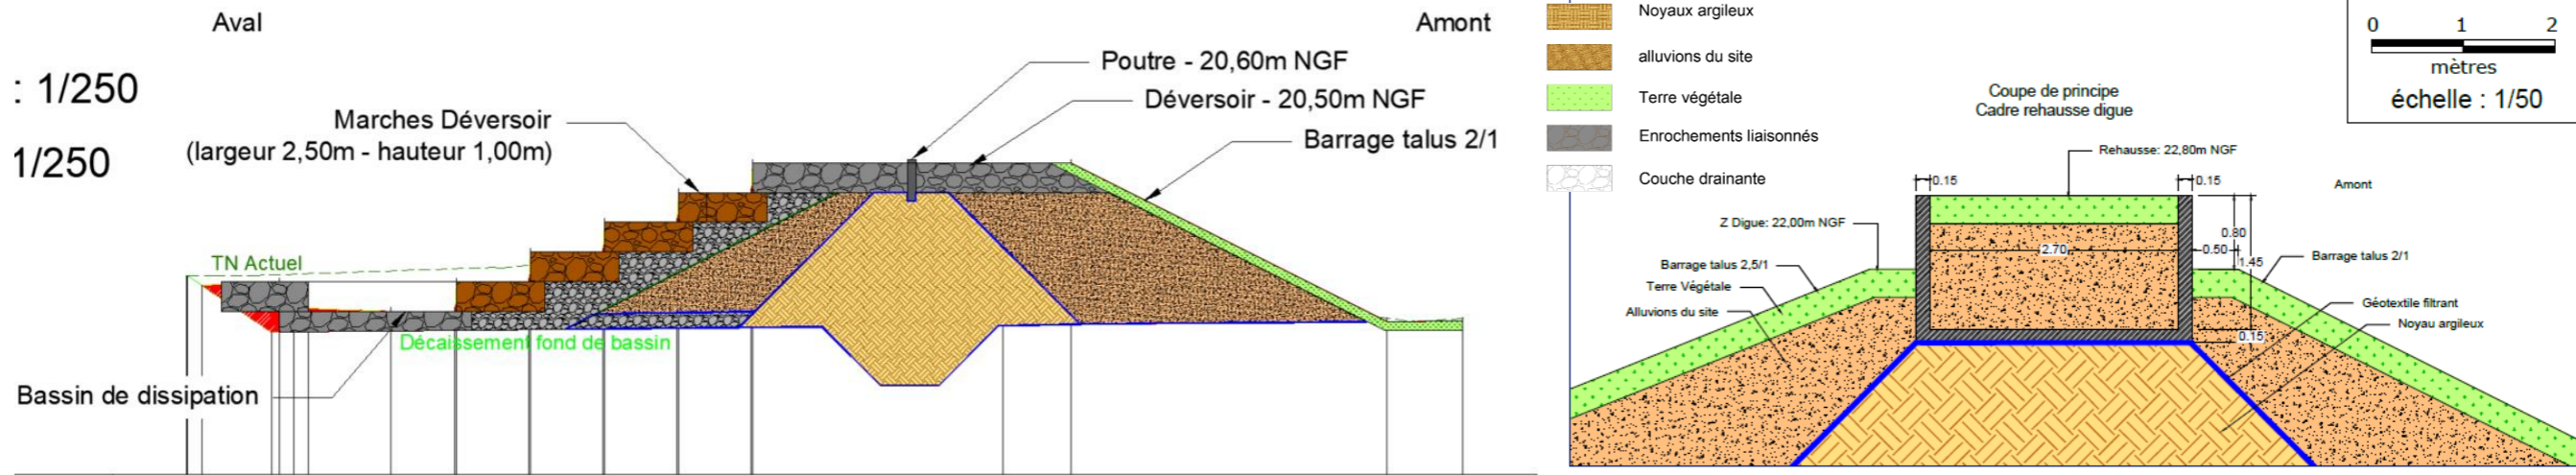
Coupe A-A' de la section déversante à gauche, et coupe au droit de la section courante en rive gauche à droite – plan AVP
